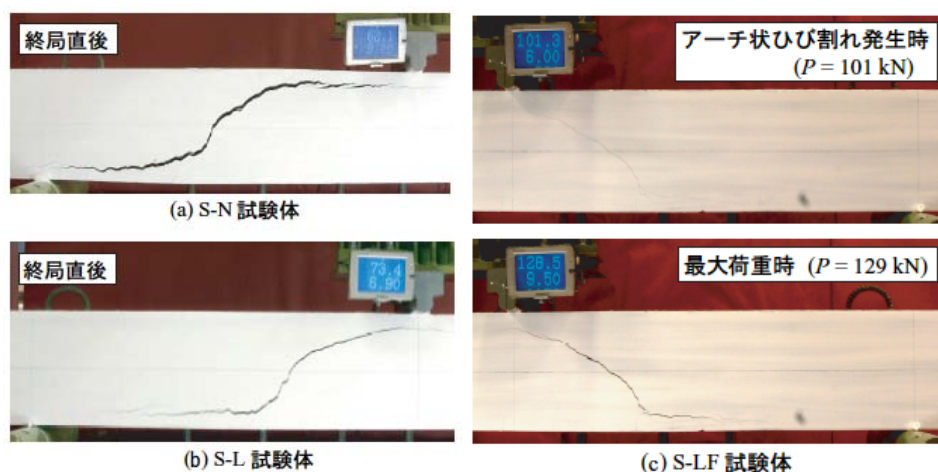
S梁に関する最大荷重近傍のひび割れ性状
